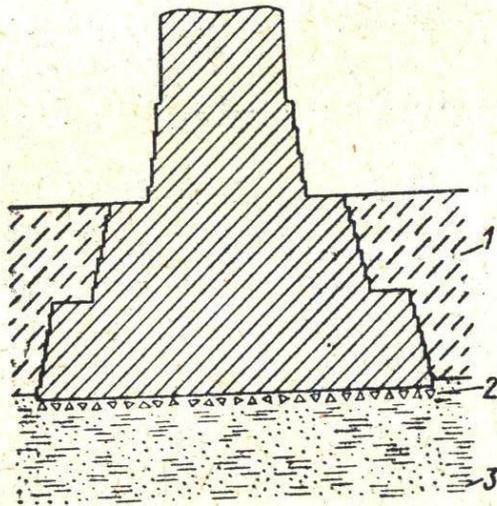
Фундамент, расположенный непосредственно на пльвуне. К основанию фундамент расширен.
